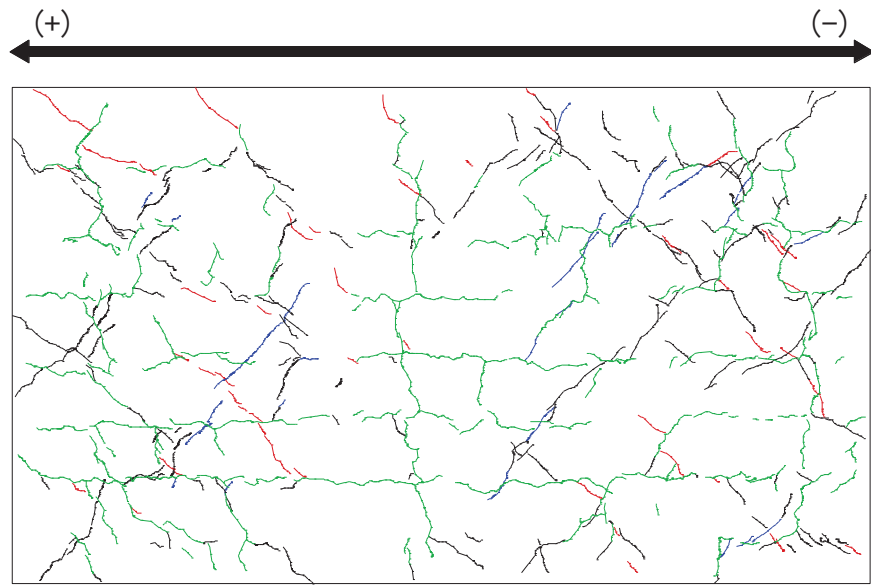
(7) 乾燥試験体 [2] 1/1250rad. におけるひび割れ図
